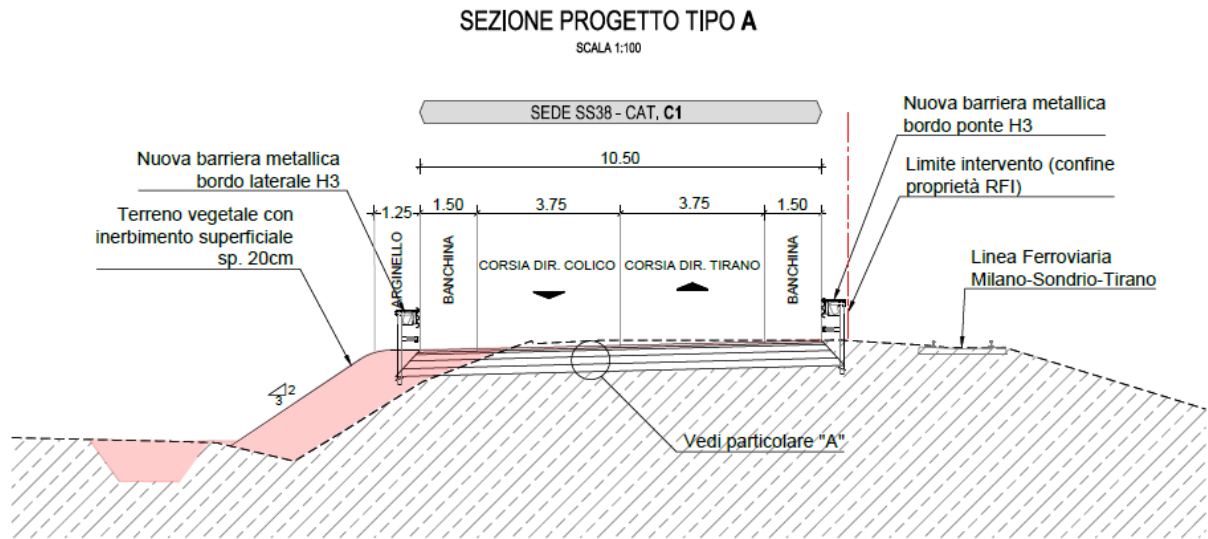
Sezione tipologica allargamento in rilevato- asse principale
